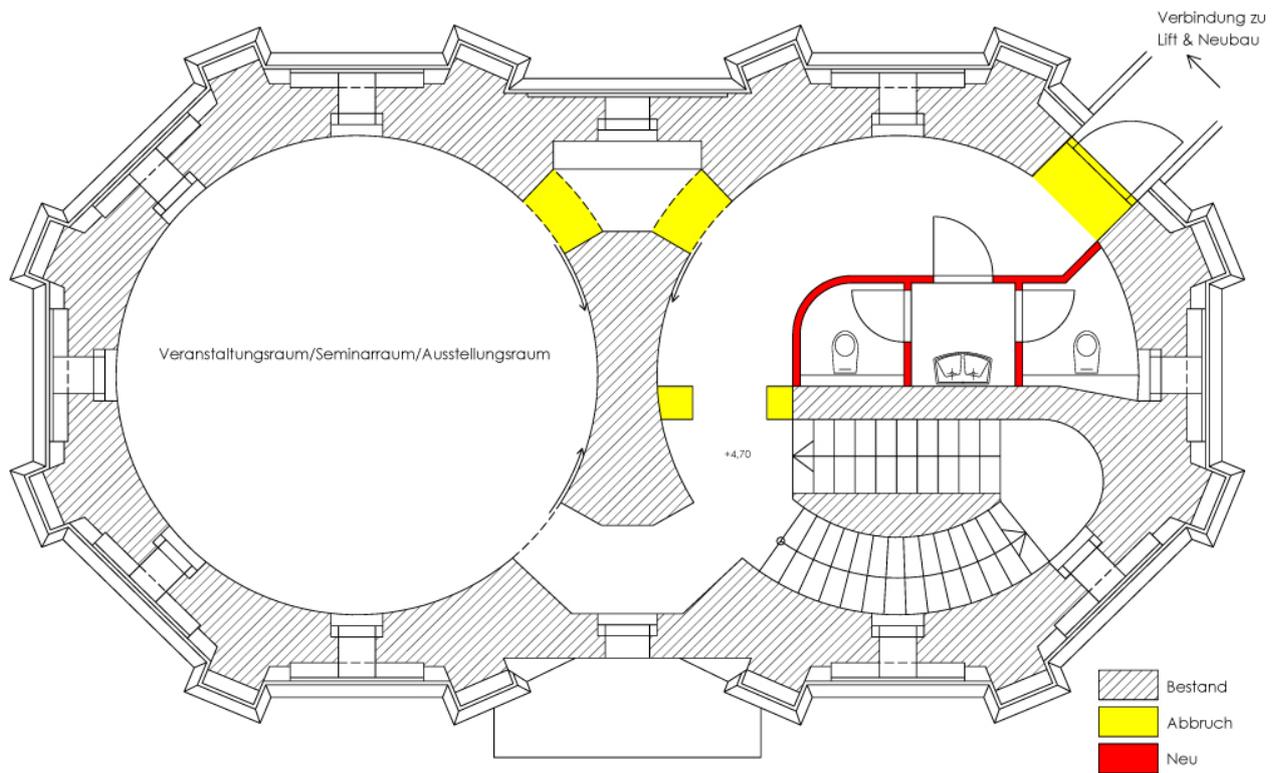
Grundriss Ebene 1 Wasserturm - Veränderungen
